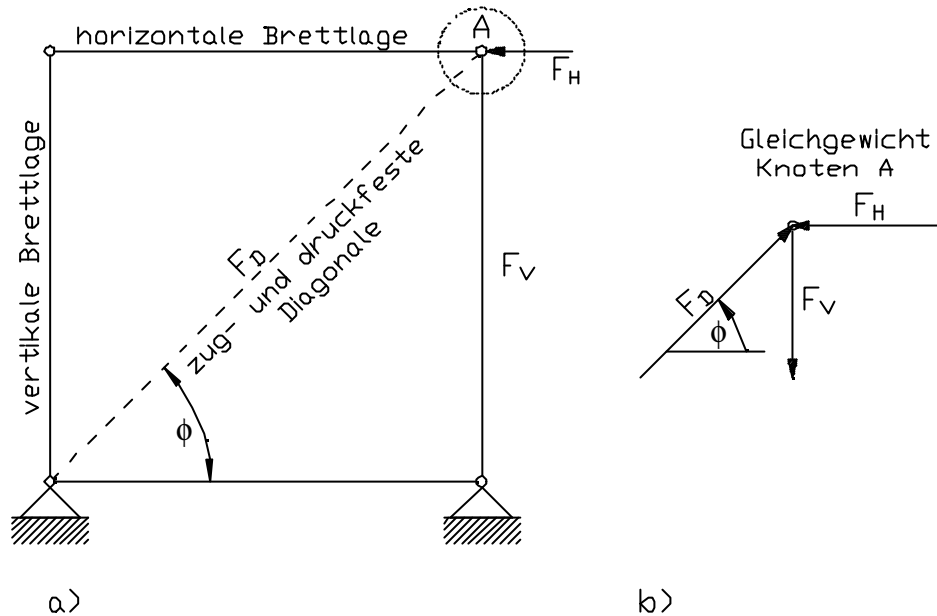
Gleichgewicht an einem Ersatzmodell für Brettlagenholz mit orthogonaler Struktur
